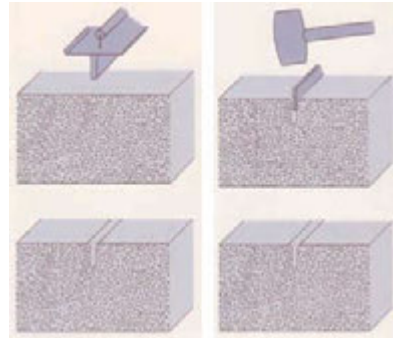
Aparición de fisura por debajo del corte de la sierra.
